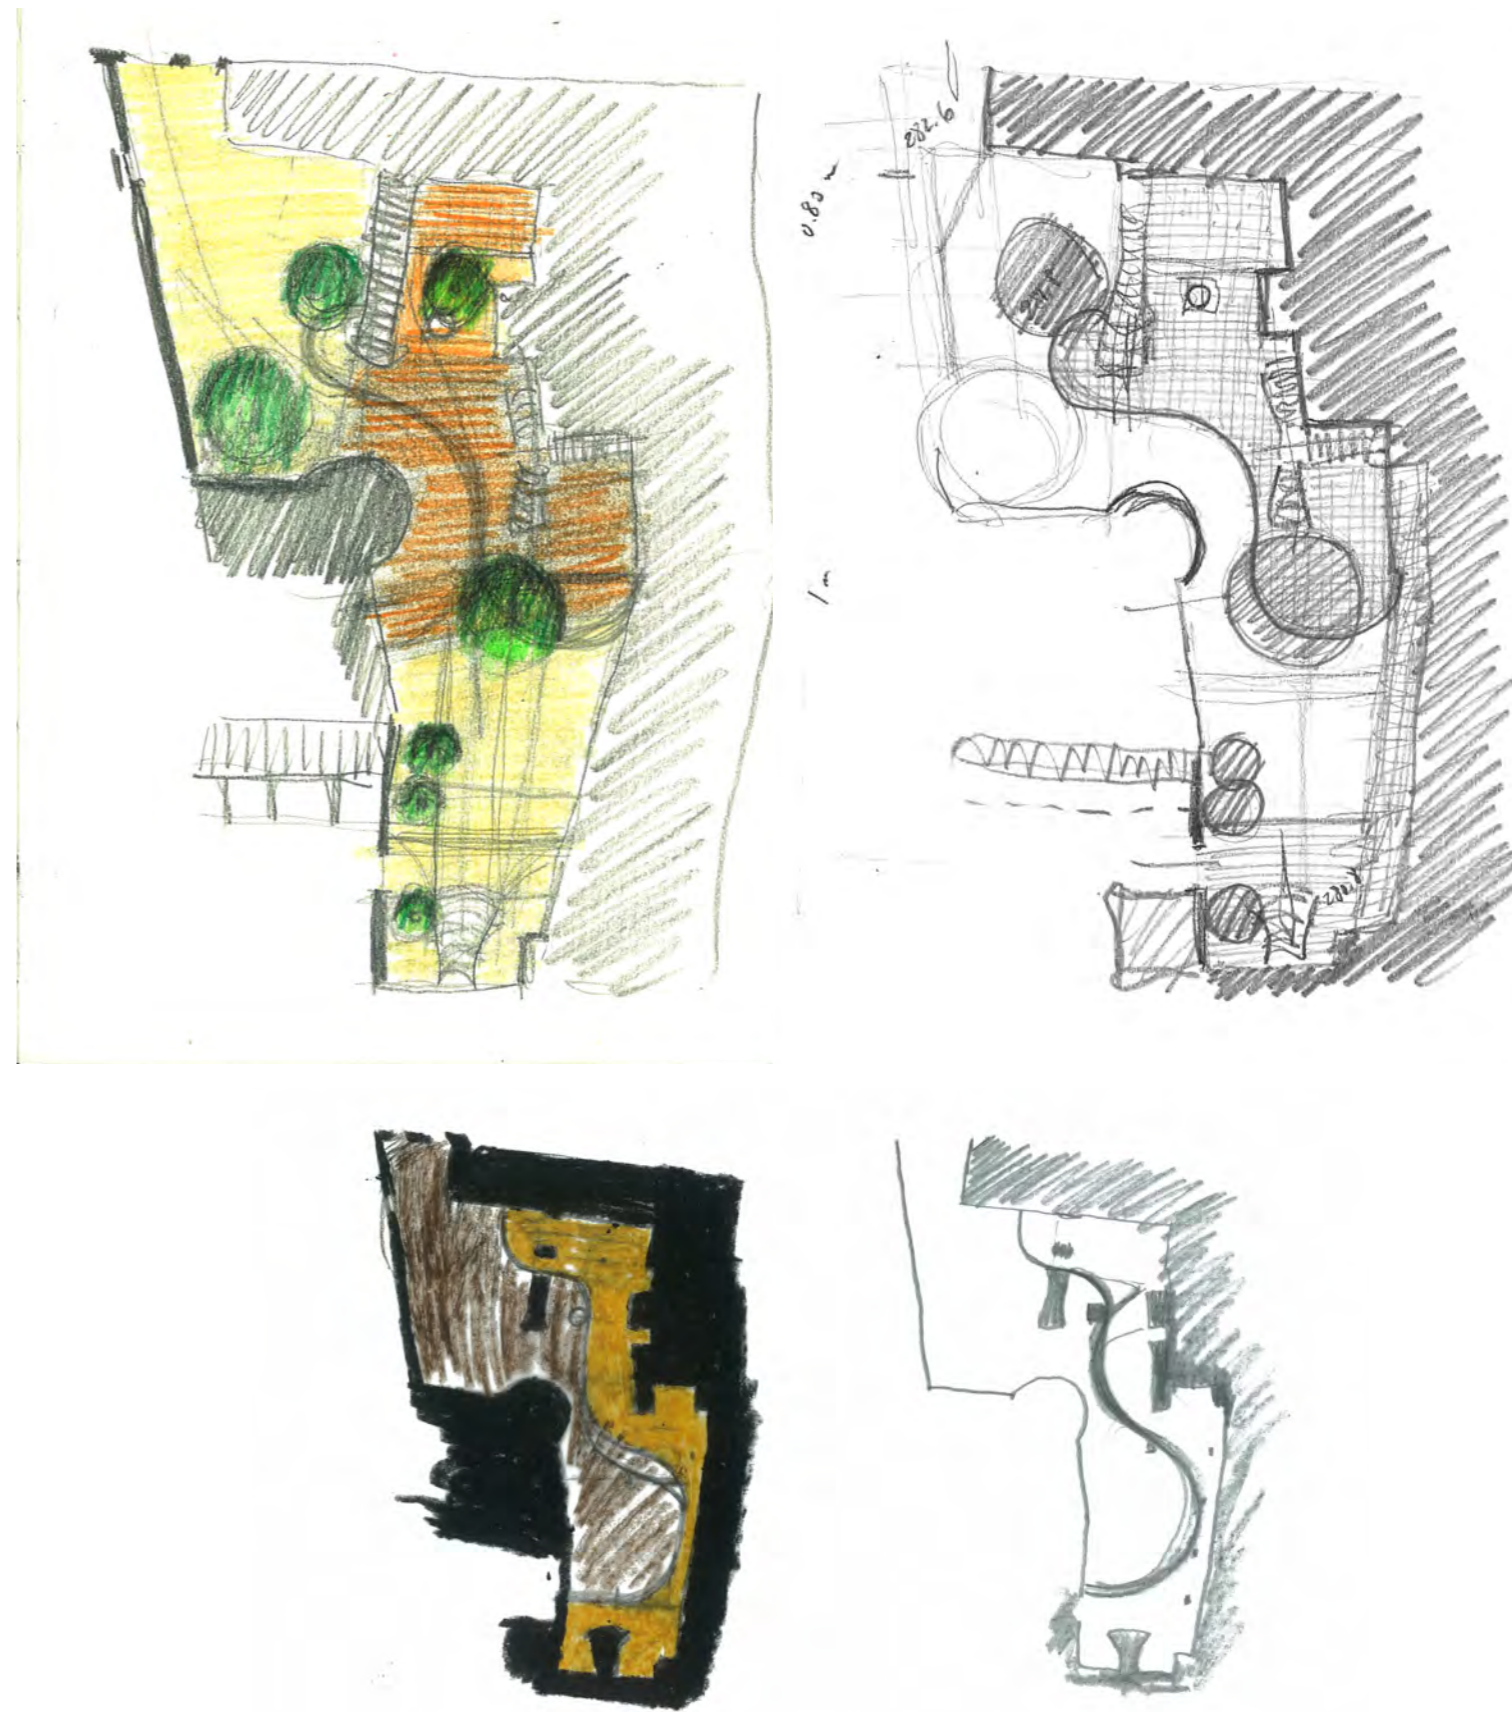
Esquissos do desenvolvimento da marcação do pavimento no pátio da Casa Nobre.
